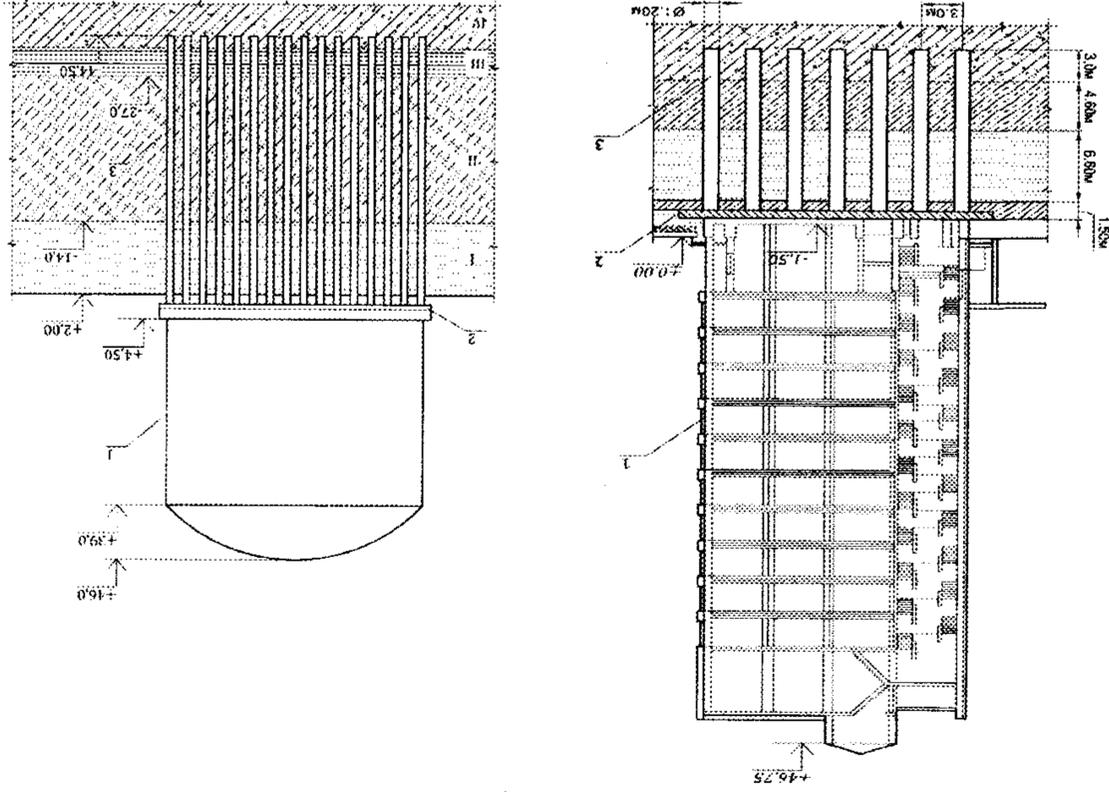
Применение стальных электросварных труб в качестве свайных оснований зданий (а) и резервуаров (б)
